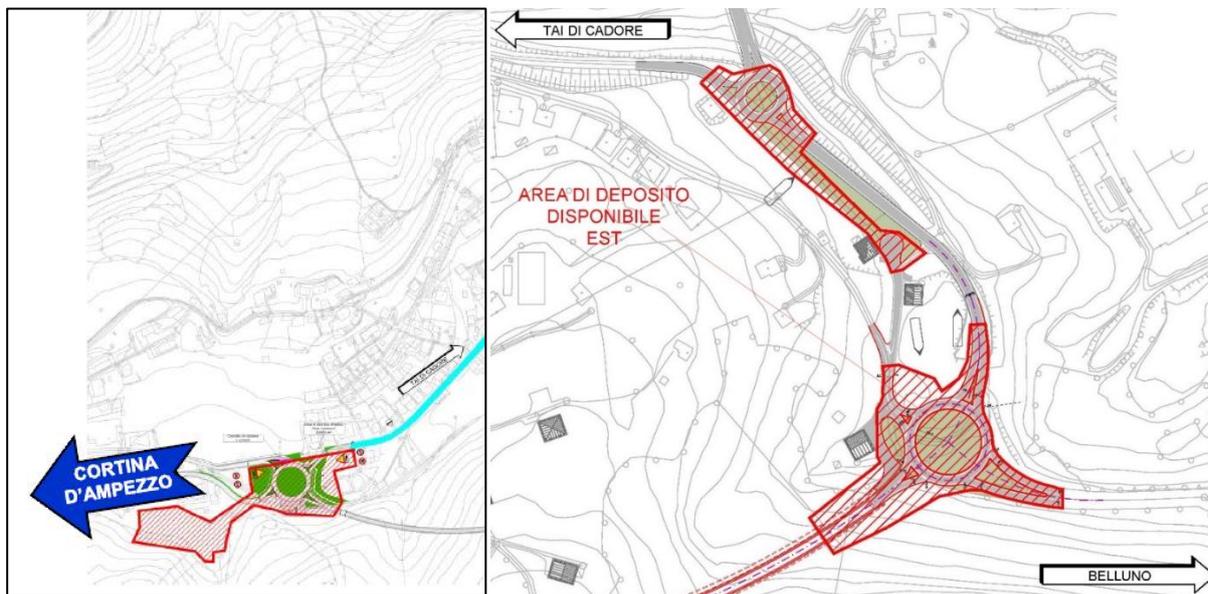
Stato di cantiere dell'area in esame: aree di cantiere in direzione Ovest (sx) ed Est (dx)
